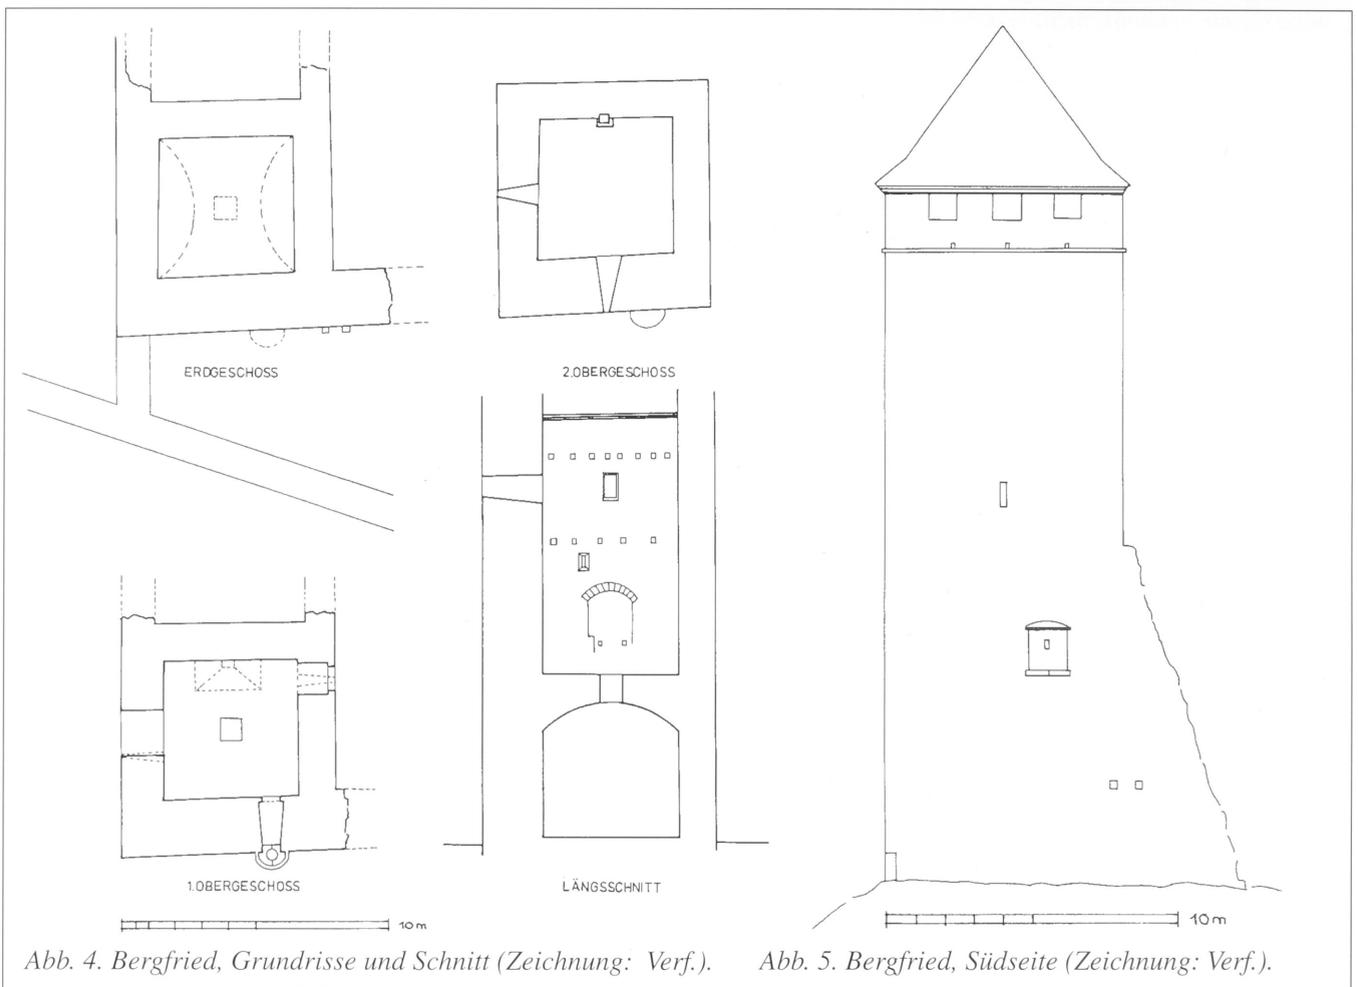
Bergfried, Grundrisse und Schnitt (Zeichnung: Verf.).
